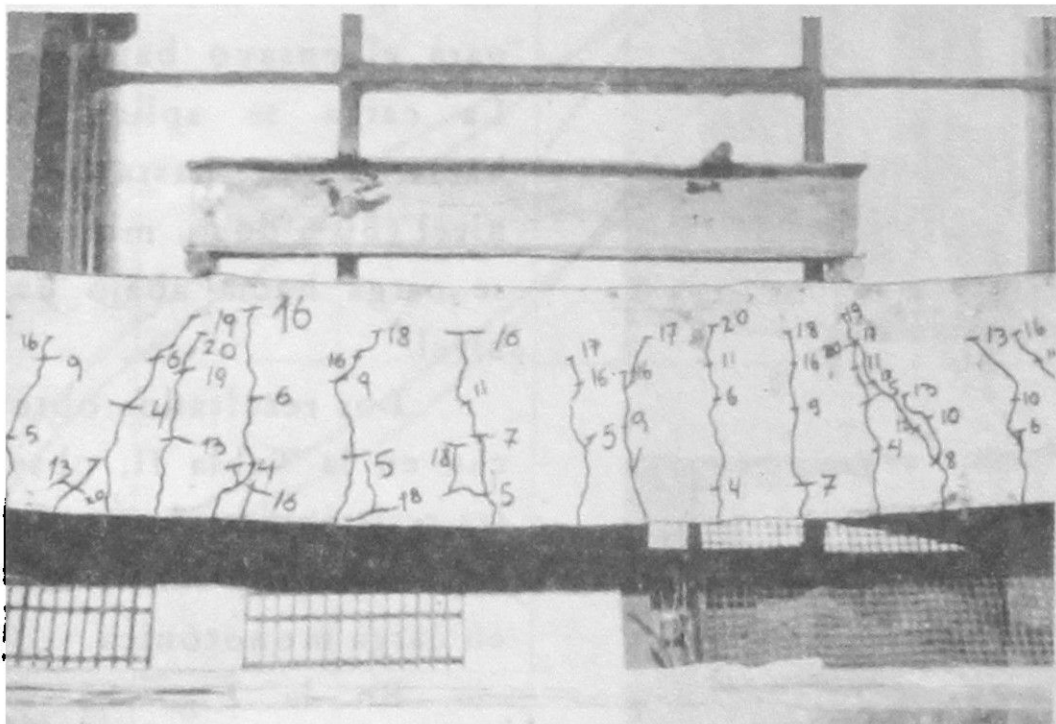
Estado de agrietamiento final. Viga sin empalme.
